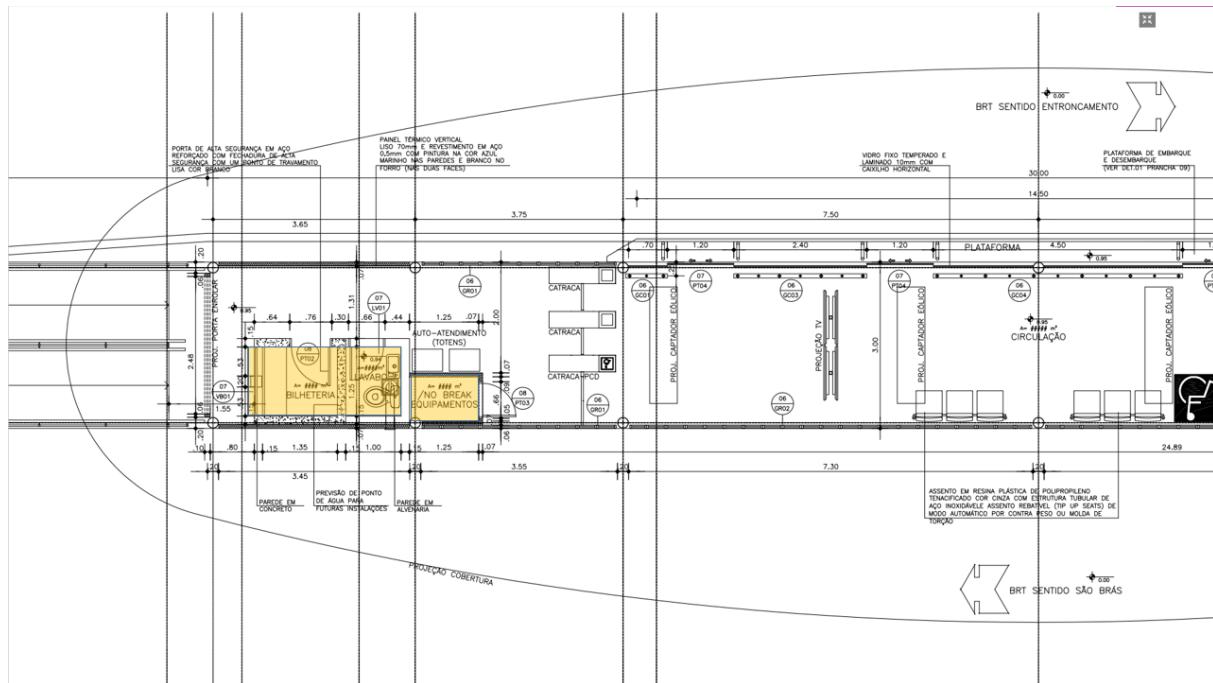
Área do Posto de Venda (Bilheteria e Apoio) das Estações de Passageiros “Tipo 2” da Avenida Almirante Barroso
